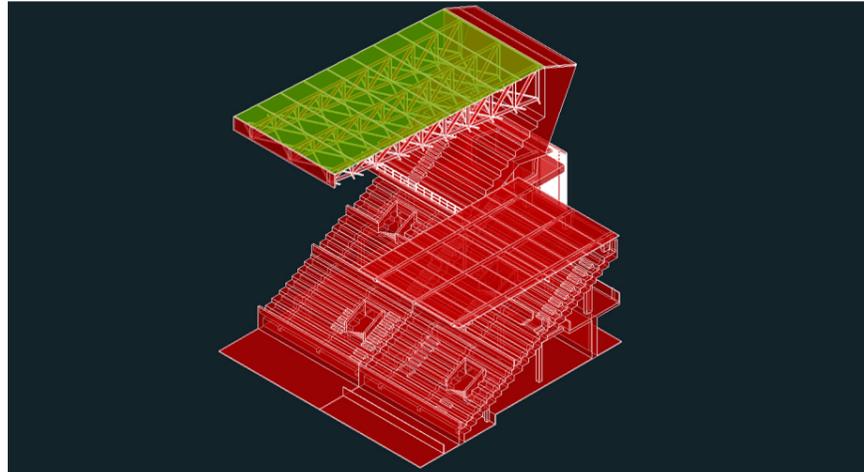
Axonometría de un trozo de sección del actual estadio y de la propuesta, modelado en Autocad.
